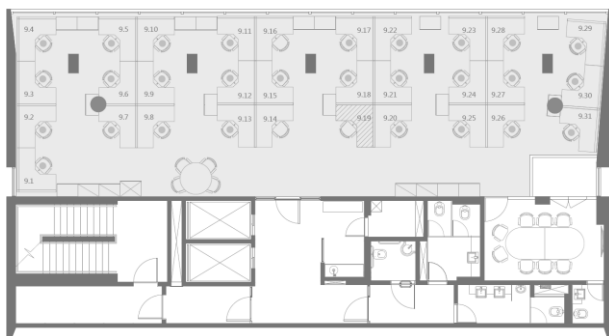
Planta baixa do pavimento tipo, com destaque na área destinada ao uso de escritório (2016).
